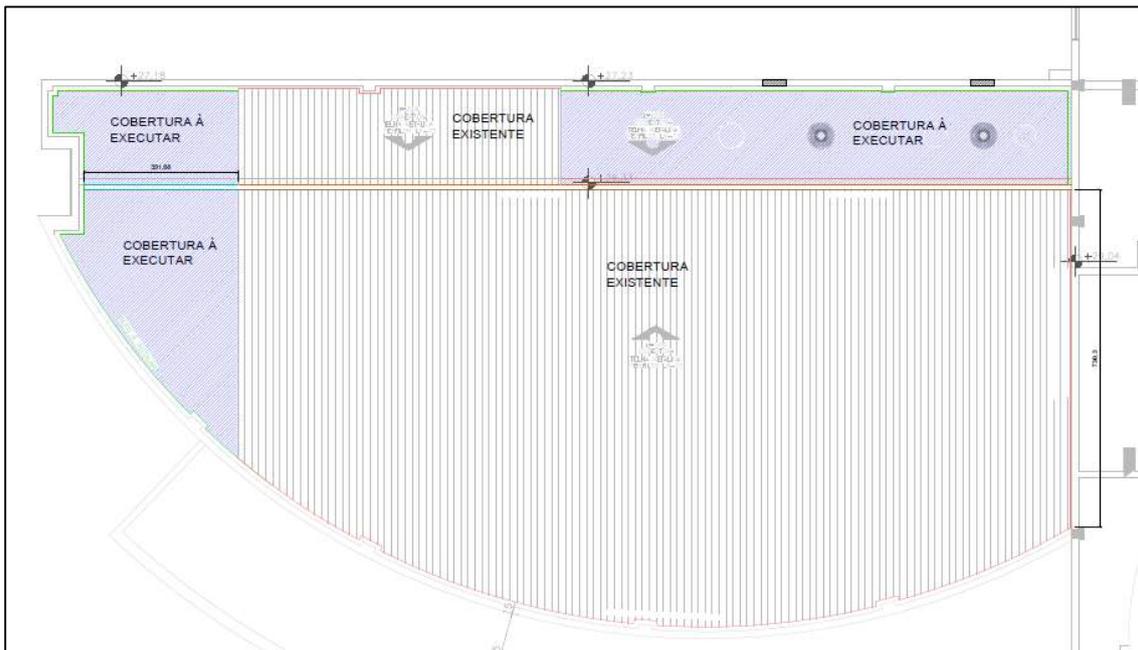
Croqui esquemático. Os locais de instalação do complemento da cobertura estão hachurados em azul
